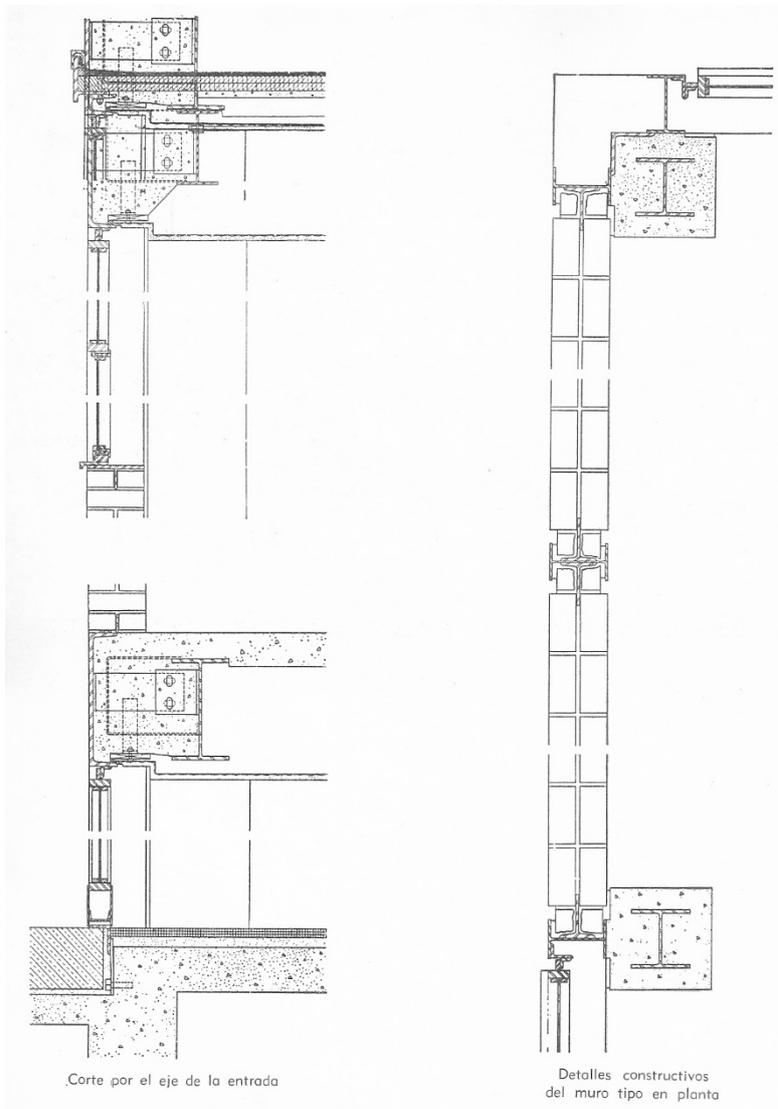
Detalhes (corte e planta baixa) das fachadas do *Alumni Memorial Hall*. Fonte: JOHNSON, 1960, p. 150.
